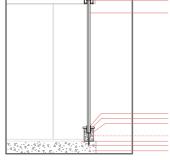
Corte por fachada Fuente: Elaboración propia 2023.
